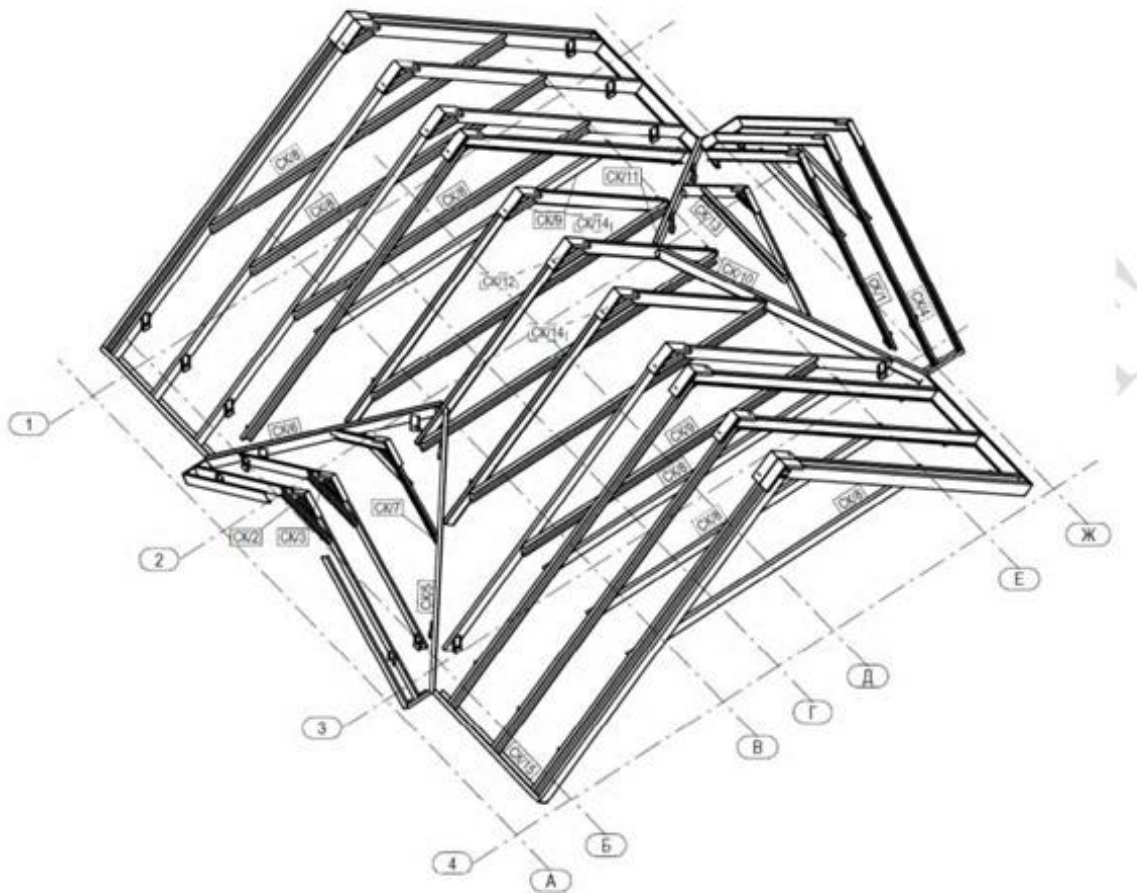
Общий вид стропильных конструкций из стропильных балок
